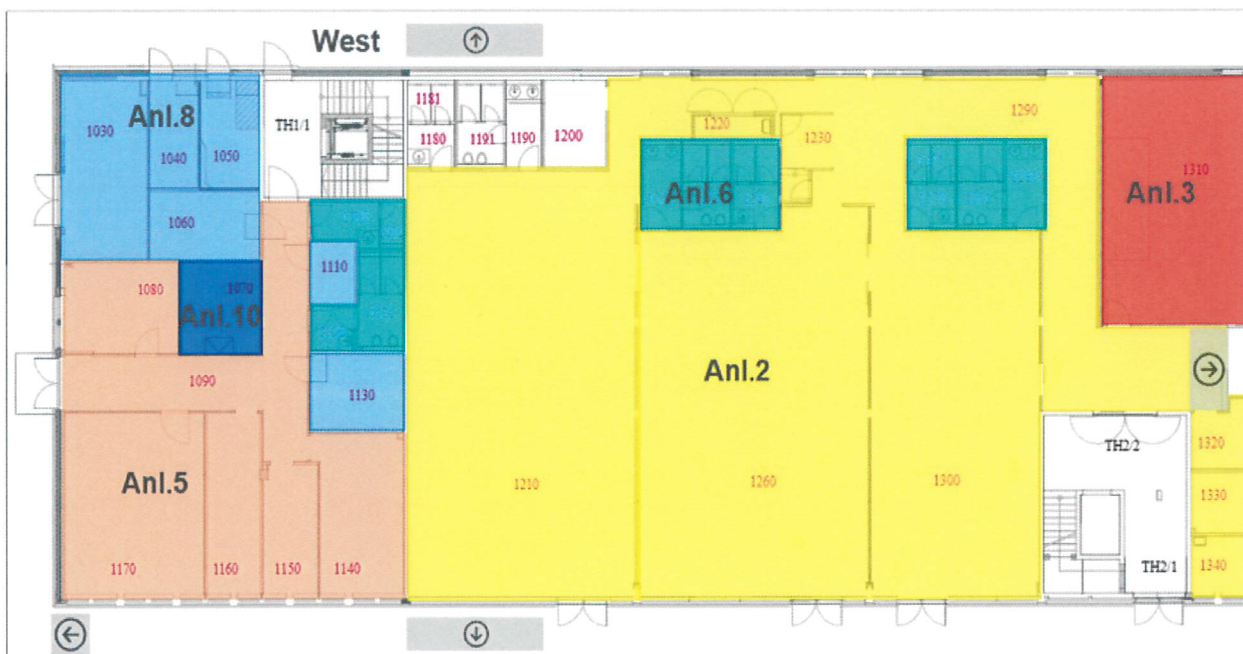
Beispiel für Wirkungsbereichsdarstellungen im Grundriss
